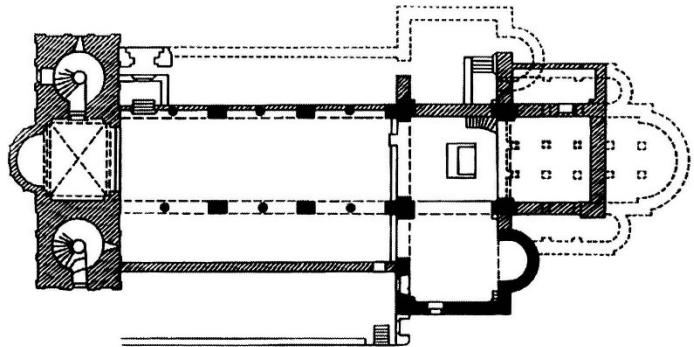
Grundriss der Klosterkirche Drübeck
